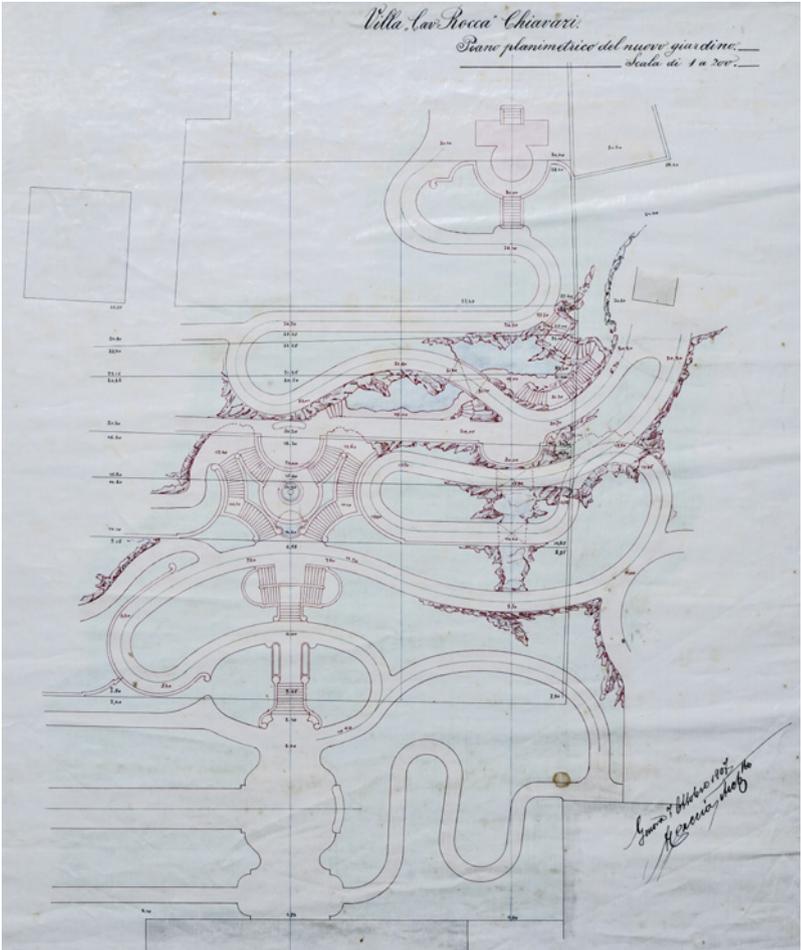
P. Caccia, *Planimetria Villa del Cav. Uff. Giuseppe Rocca Chiavari, piano planimetrico del nuovo giardino*, 1907. Archivio di Palazzo Rocca.
